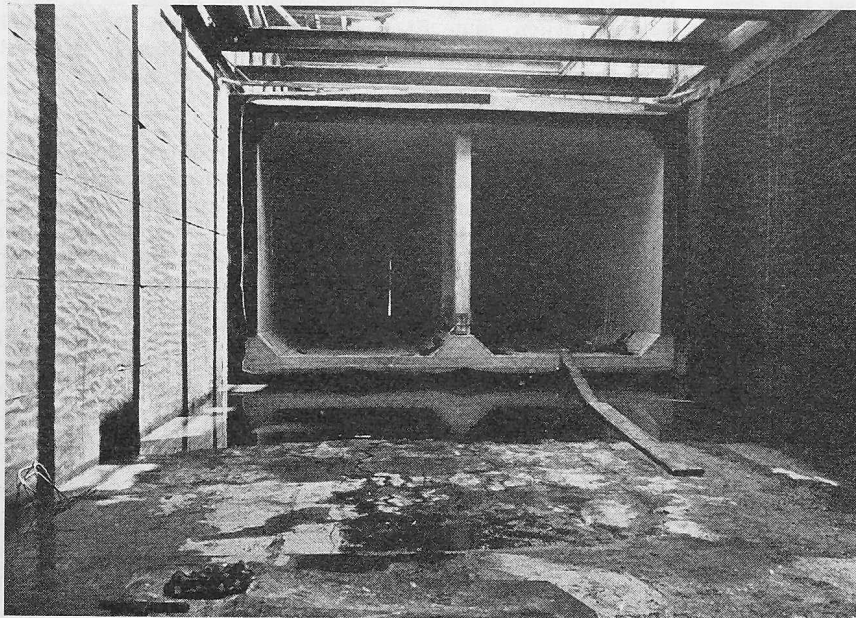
U-Bahn-Tunnel in wasserdichtem Beton
